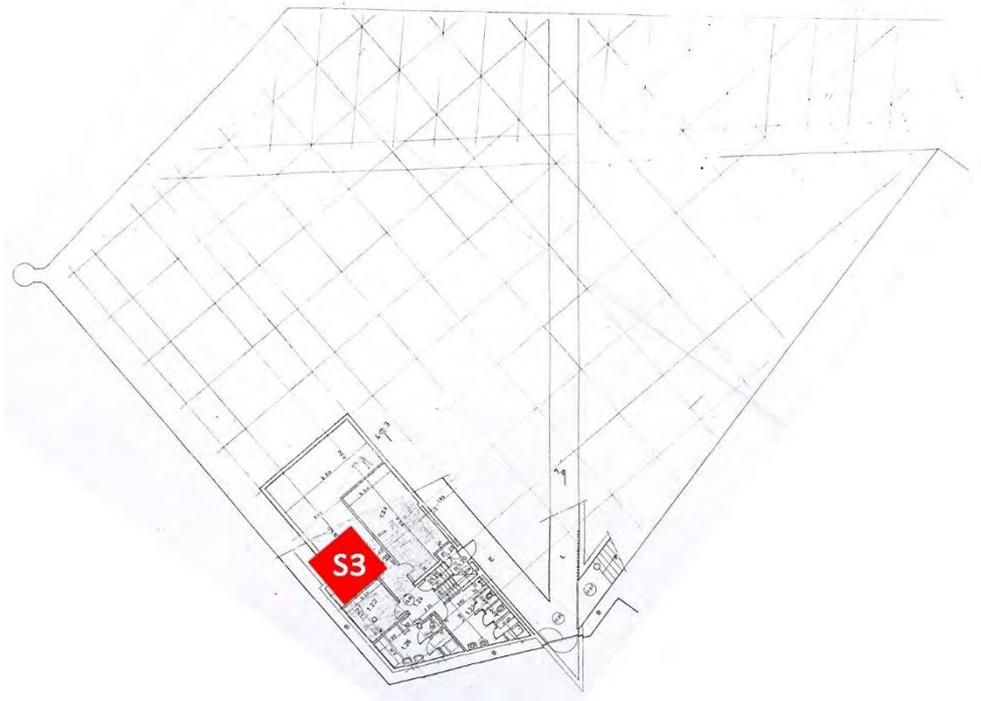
Localização da sondagem 3 sobre a planta do piso -1.
